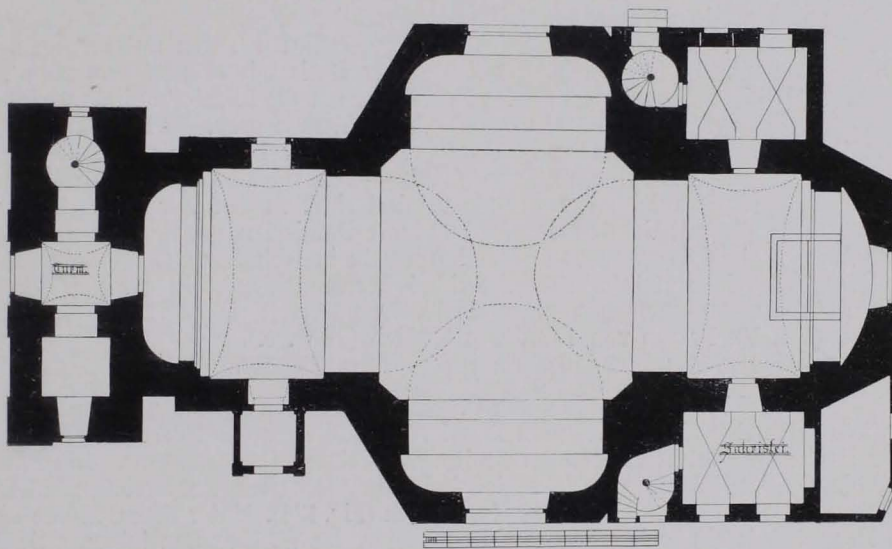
Groß-Siegharts, Pfarrkirche, Grundriß 1 : 300 (S. 133)
